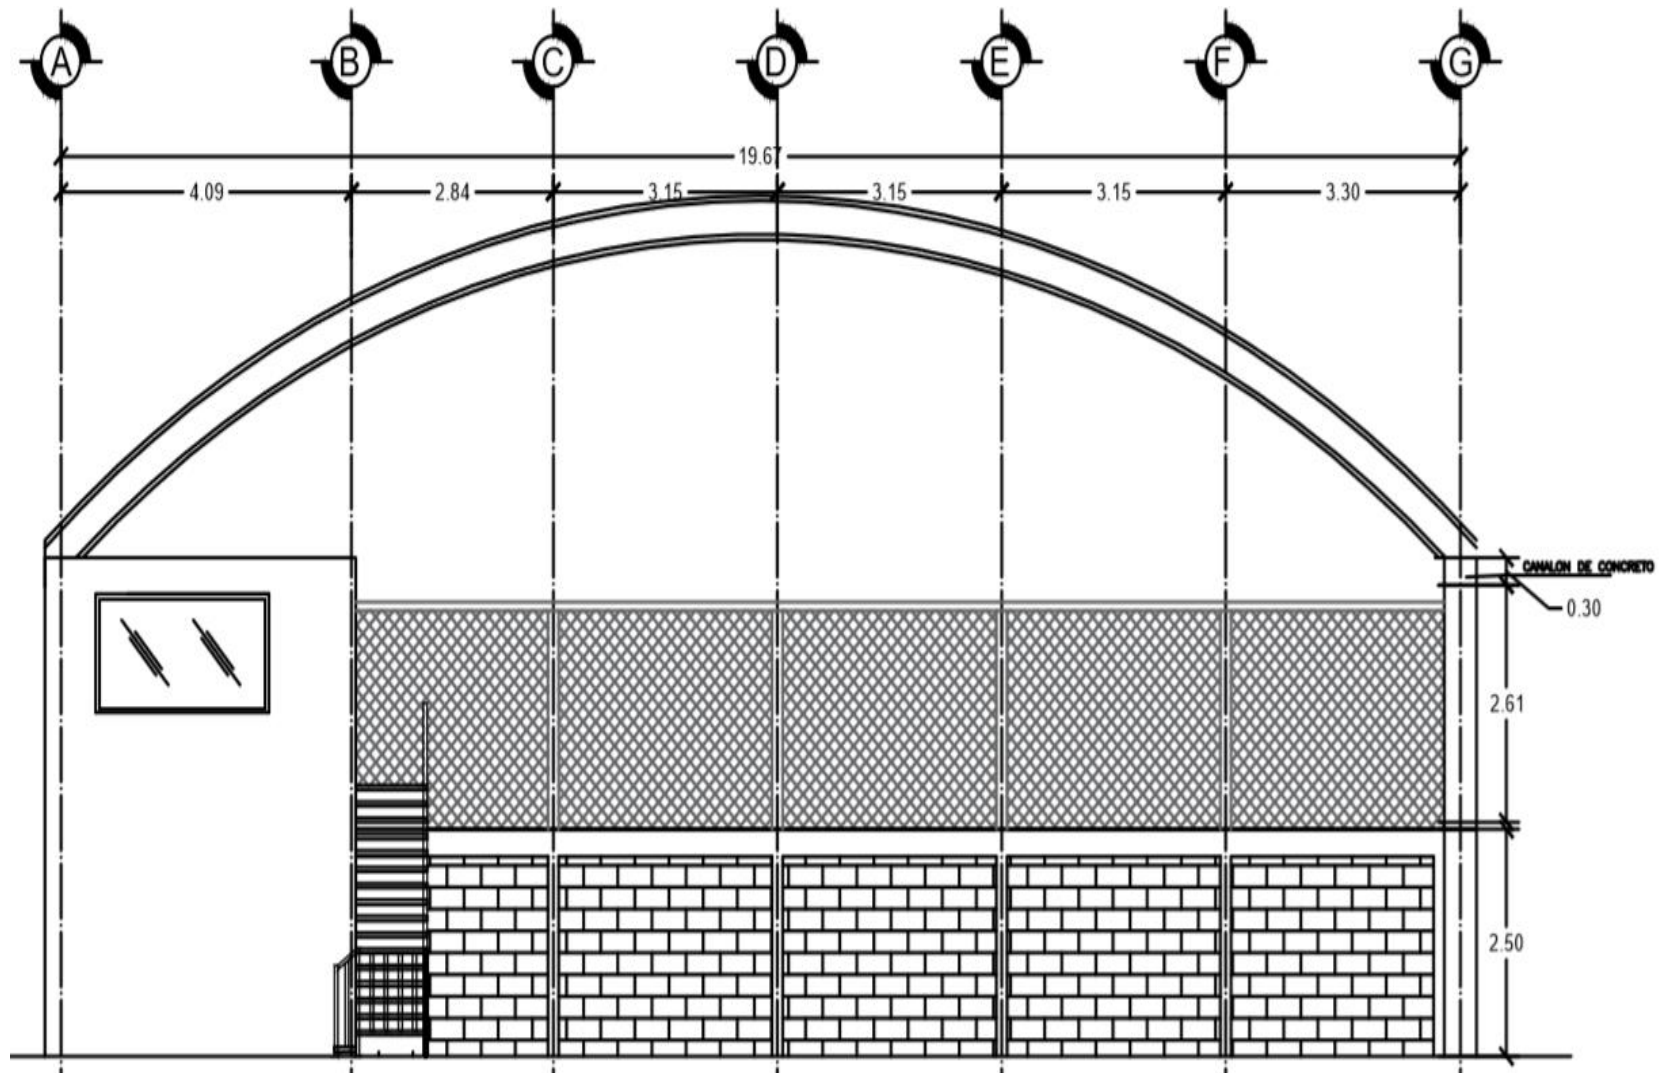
(D) Plano de la vista longitudinal del inmueble para la instalación de la planta de biodiésel
